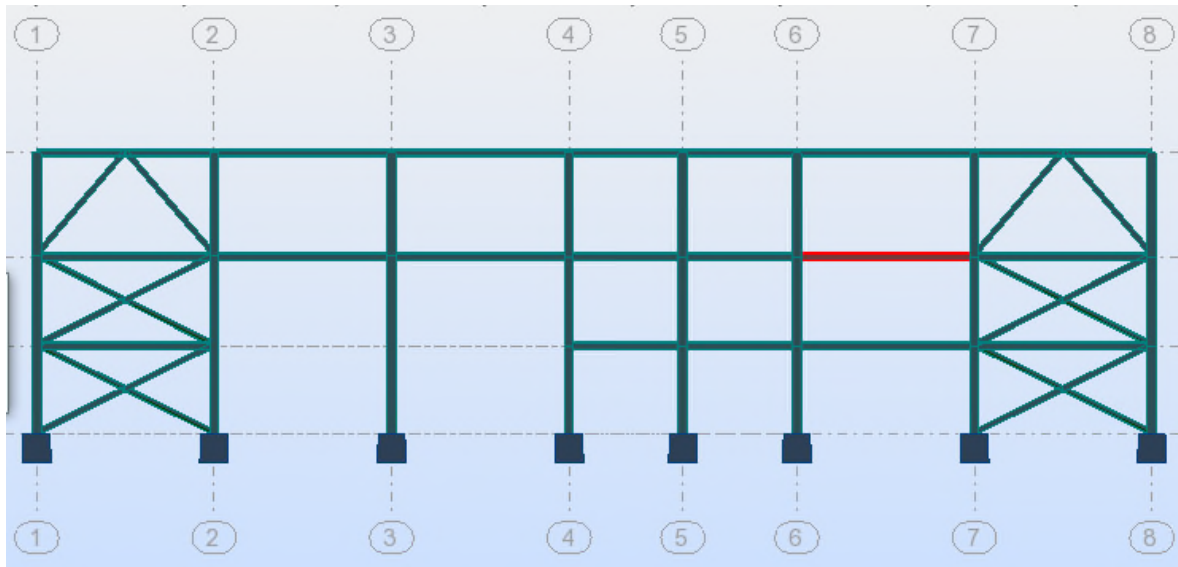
Illustration de la poutre secondaire la plus sollicitée.
